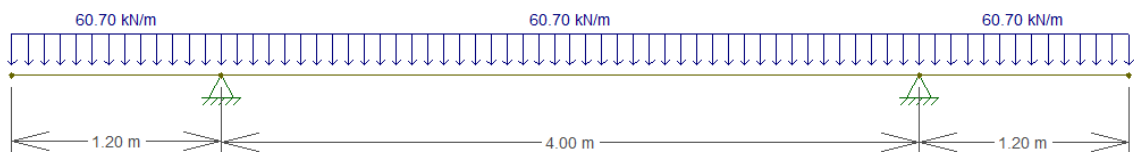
Sistema estático e carregamento nas vigas secundárias internas
